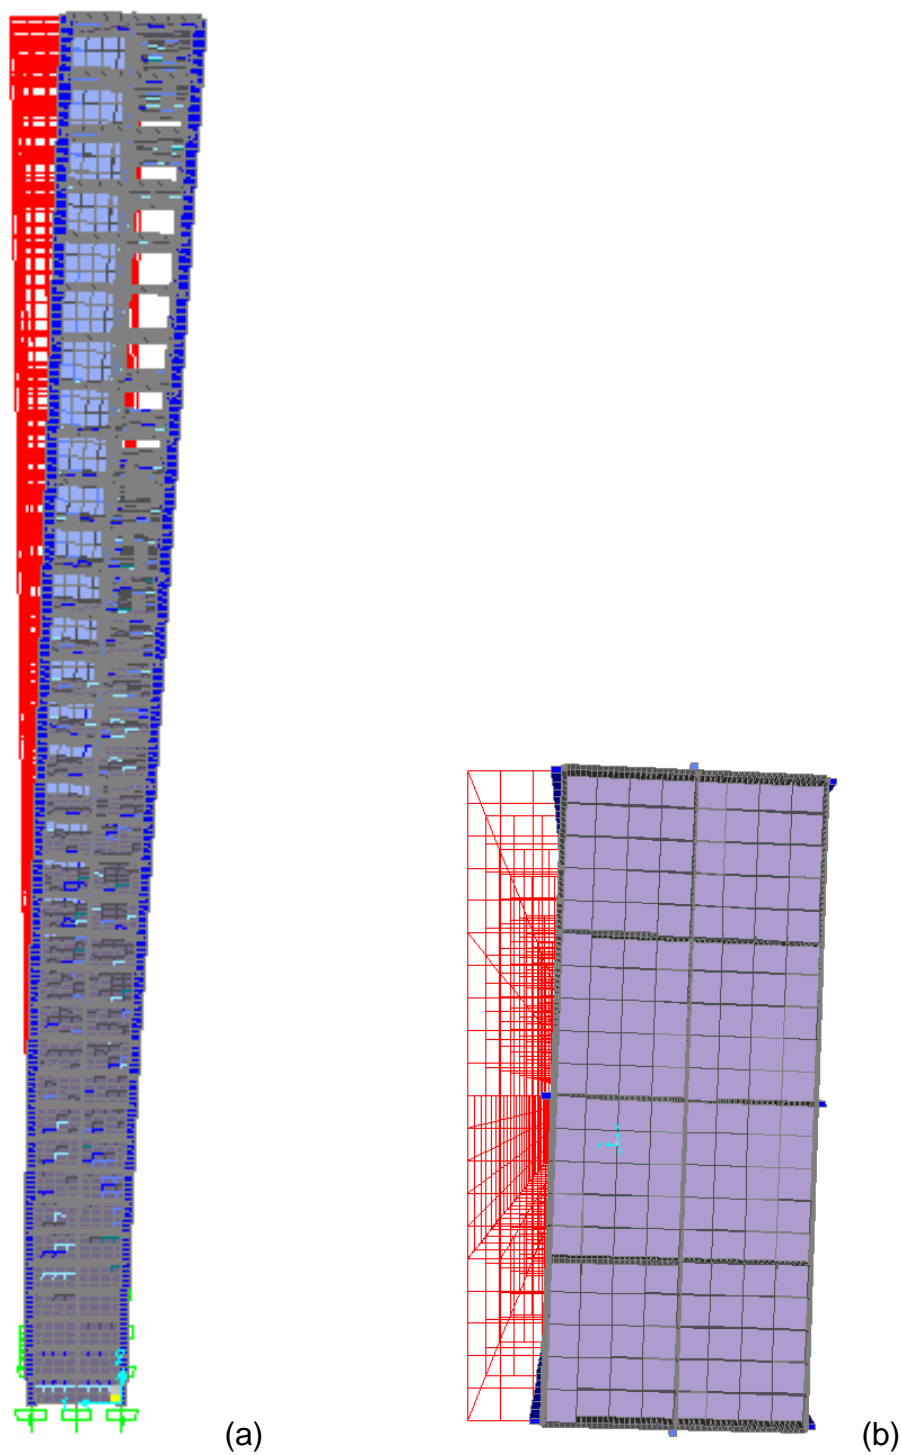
Deslocamento sofrido pela Edificação de 35 pavimentos com carregamento aplicado calculado por meio do Método Estático. (a) Vista lateral; (b) Vista Superior
